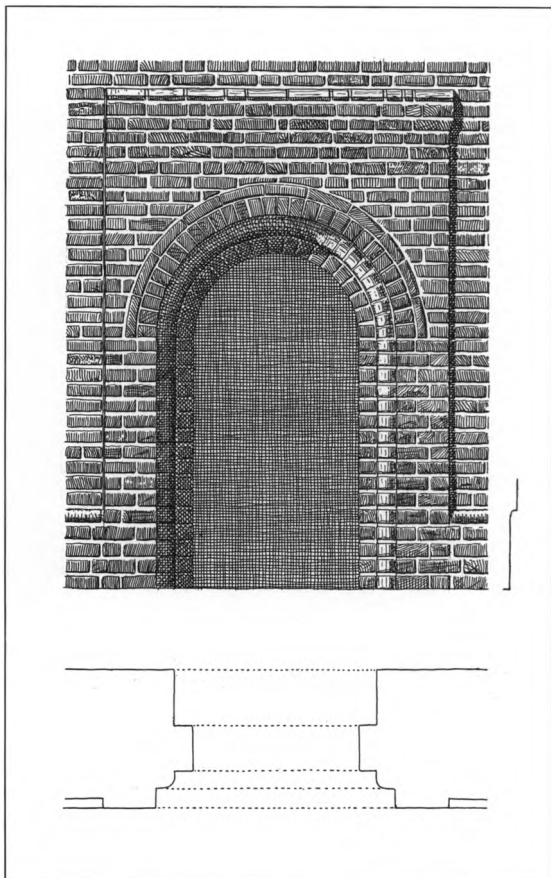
Skibets syddør (s. 2061). Opstalt og plan. 1:50. Målt af C. G. Schultz 1929. - *South door of the nave. Elevation and plan.
